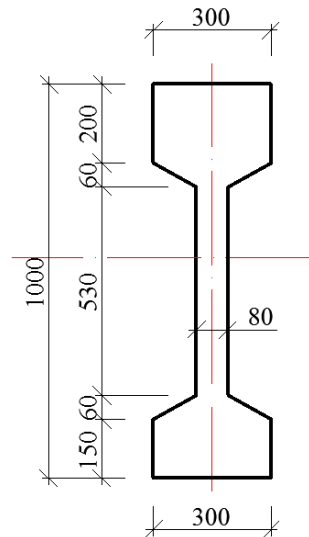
Основні геометричні характеристики поперечного перерізу з/б балки.
